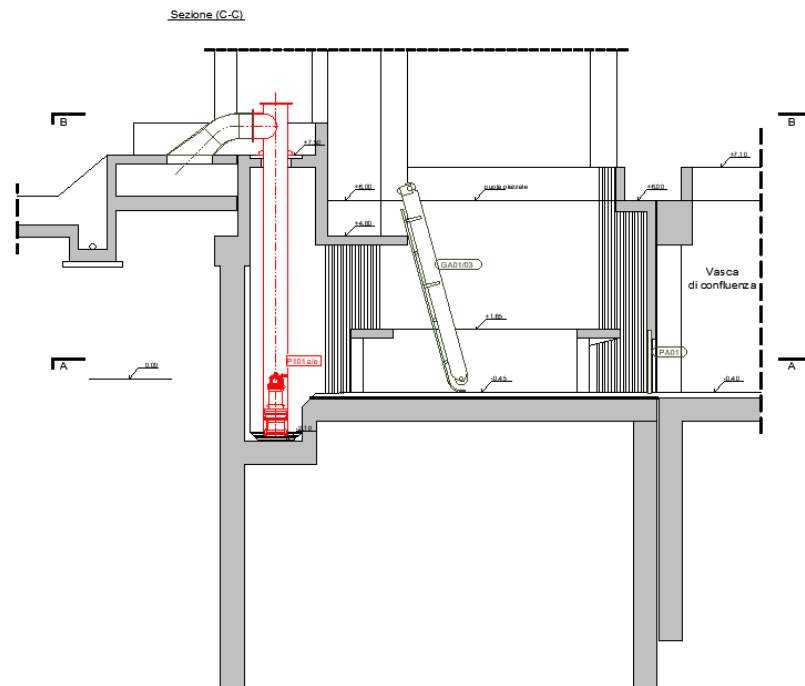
Sollevamento iniziale – Stato di progetto – Sezione
